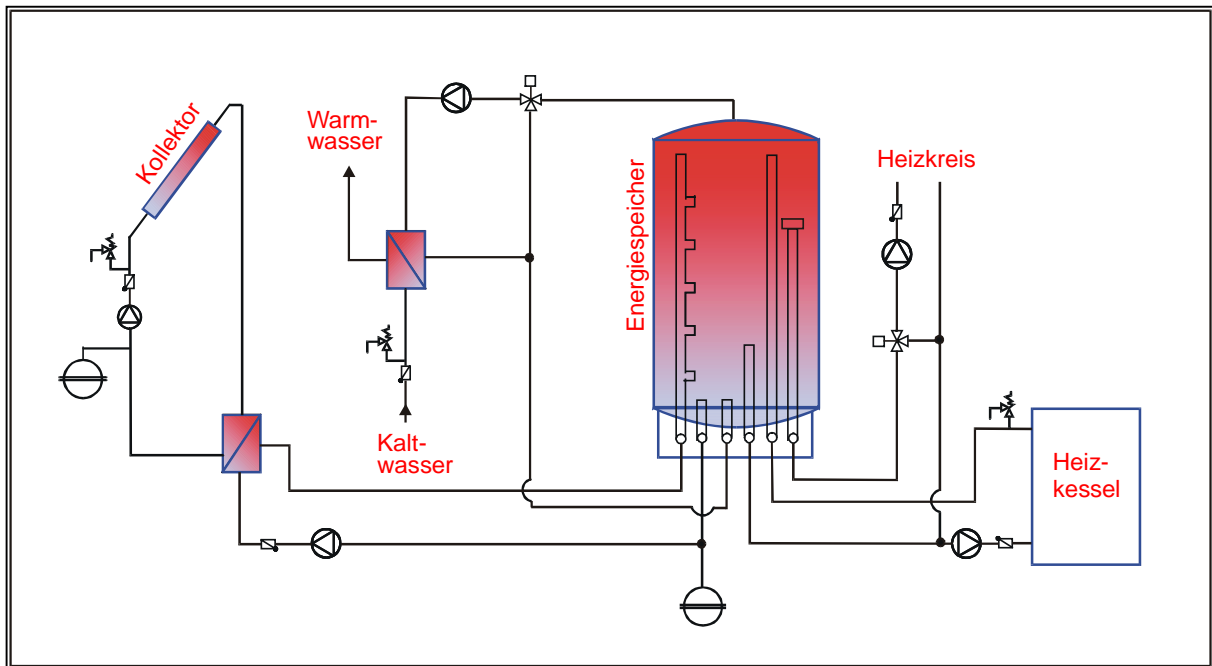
Hydraulischeschema einer Solaranlage zur teilsolaren Raumheizung (Zentraler Energiespeicher mit externer Brauchwasserbereitung)
